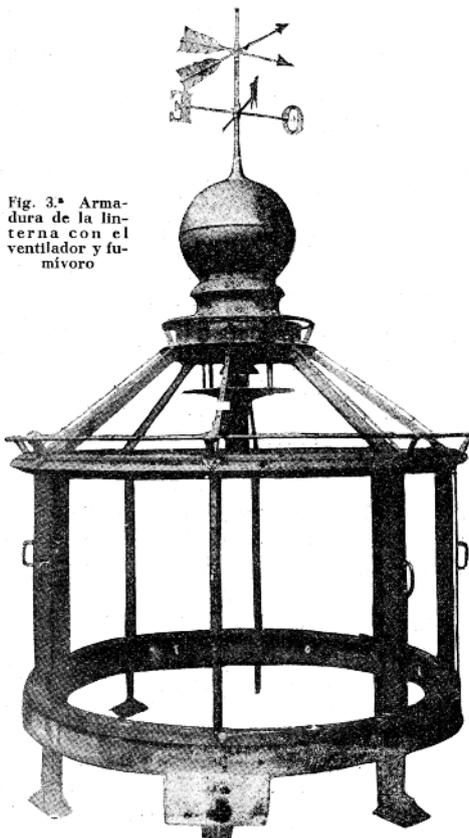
ª Armadura de la linterna con el ventilador y fumivoro
